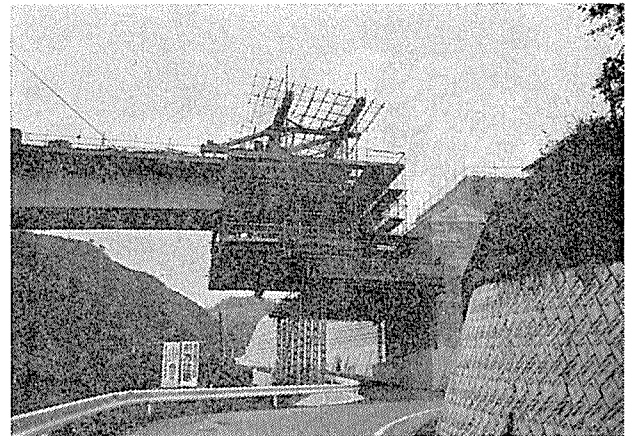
第28ブロックの施工(町道を跨いでいる状況)
